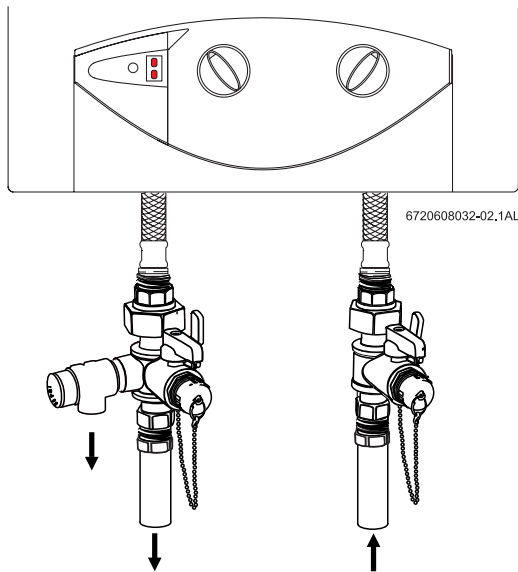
Raccordement des conduites et de la soupape de sûreté
